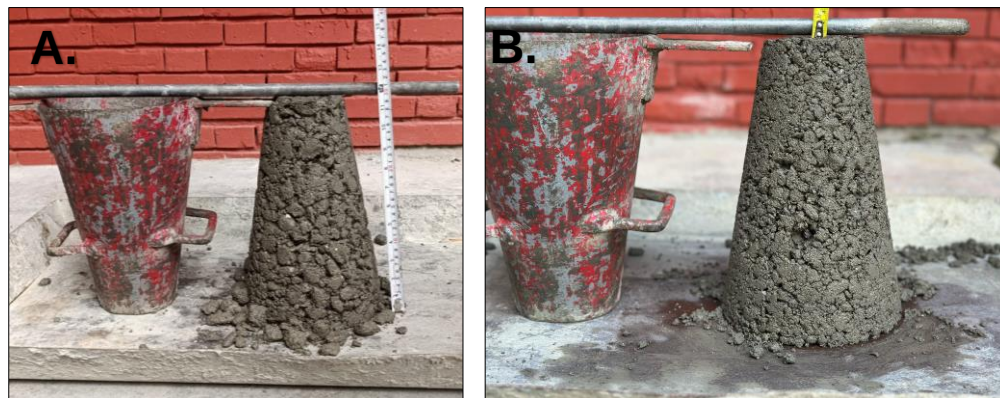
Ensayo de asentamiento para bloques de mampostería Fuente: propia.
